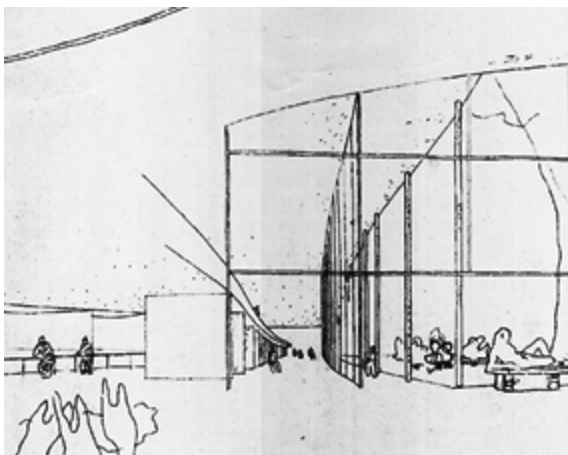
Detalhe da perspectiva da fachada sul - circulação do corpo longitudinal - espaço de transição entre interior e exterior. Niemeyer utiliza os painéis de vidro para suavizar as barreiras do construído e não-construído em seu projeto.
